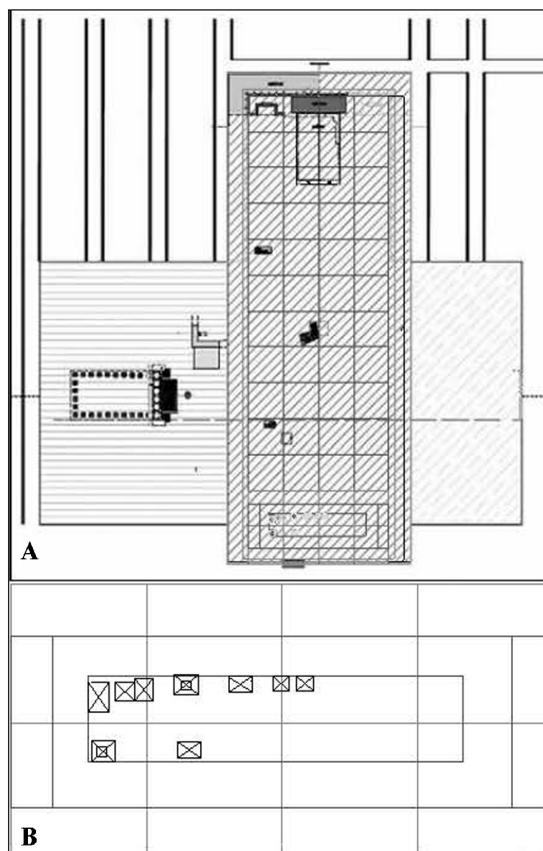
A. Modulación de 55 pies sobre plano Buzón 2011:120, fig.46. Sobre los últimos módulos de la parte sur se inserta la planta teórica de la basílica en coincidencia con los basamentos localizados. B Detalle.
